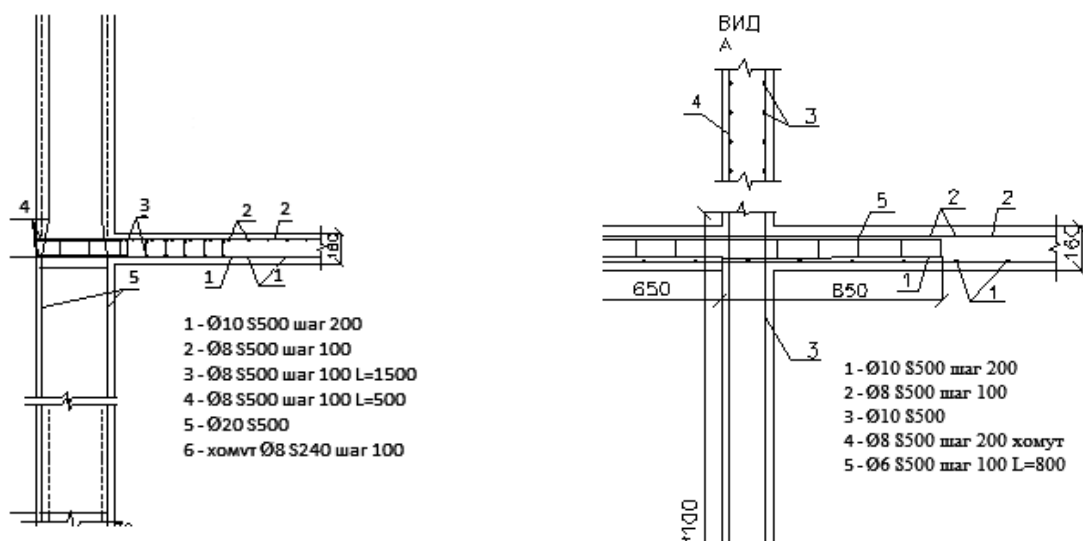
Узлы сопряжения плиты перекрытия с вертикальными конструкциями
